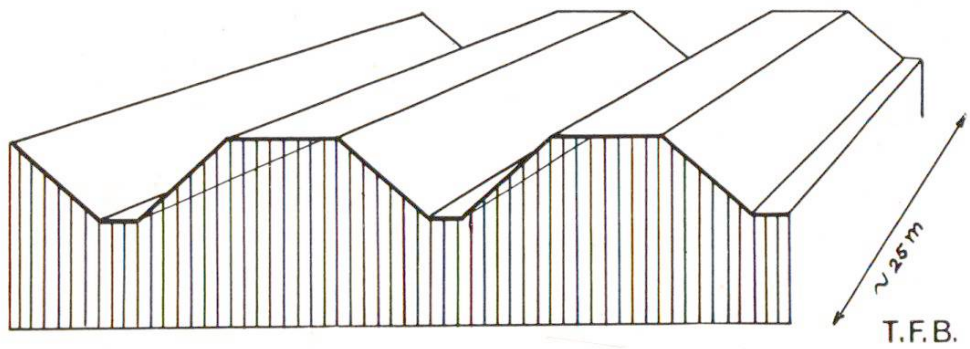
Toiture en voile mince de forme prismatique, sans piliers ni raidissements. (Concrete and Constructional Engineering, 47, 11, (1952)
